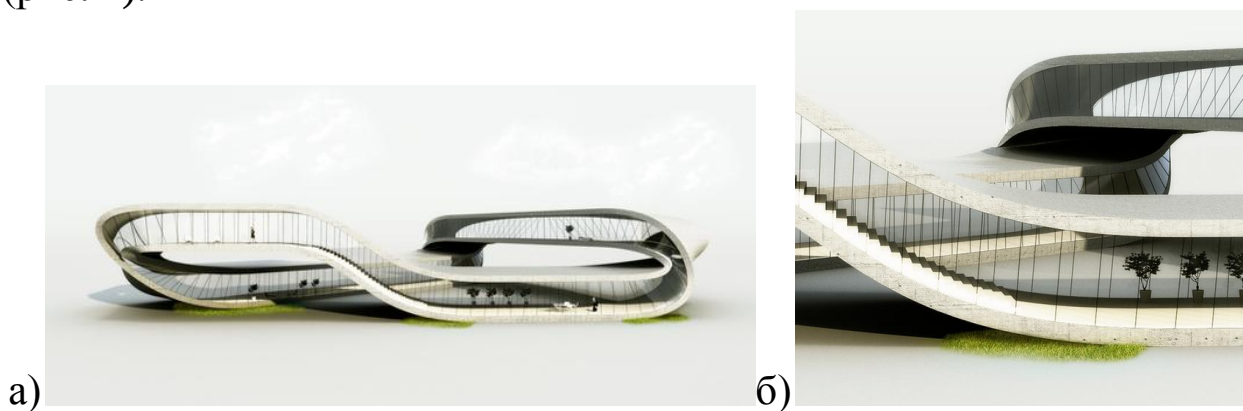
Проект The Landscape House [1]: а – вид здания; б – конструкция этажа
